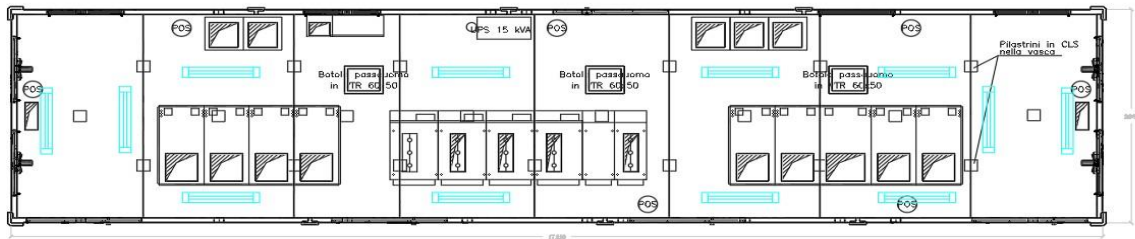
Posizionamento plafoniere Cabina Power Station e nella cabina BT/MT.
